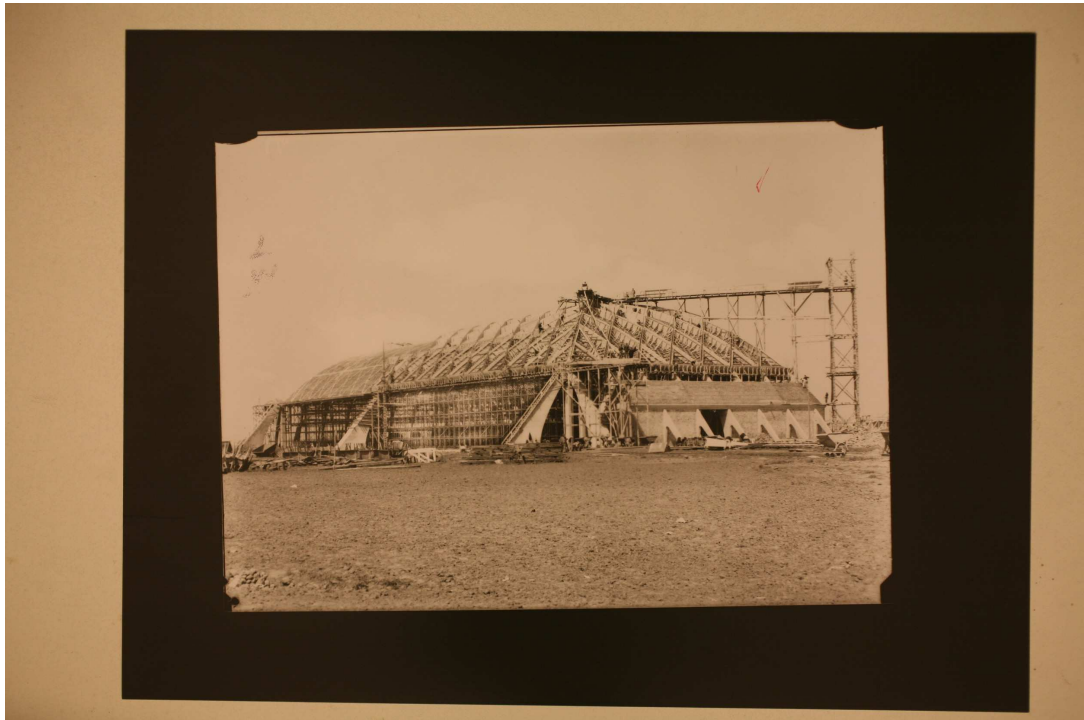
, Archivio Vasari, (Cantiere aviorimessa I tipo), 1935, CSAC, sezione fotografia.
